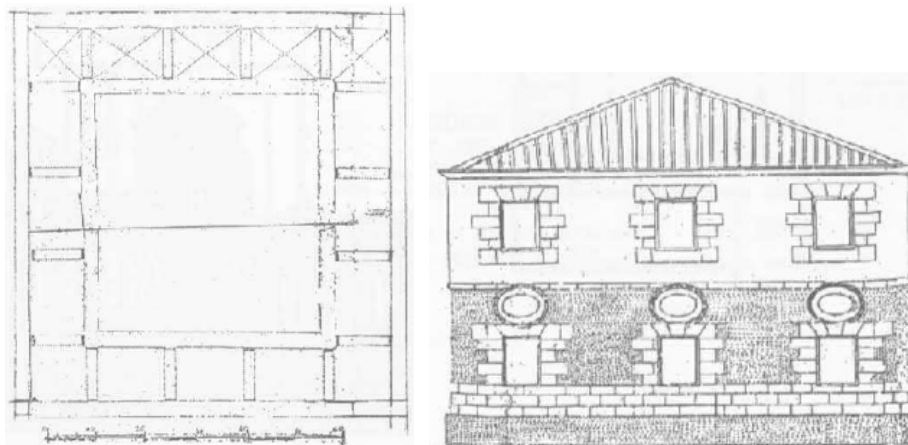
Planta y alzado del Claustro. Convento de San Francisco, 1688.
